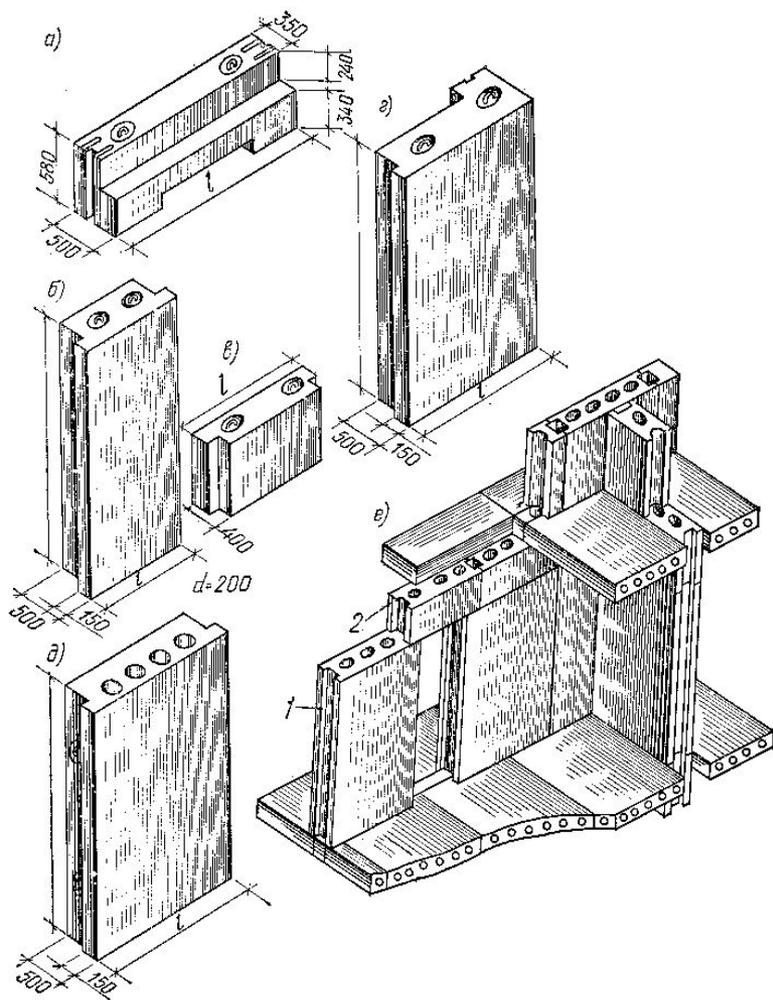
Основные типы крупных блоков стен жилых зданий:
